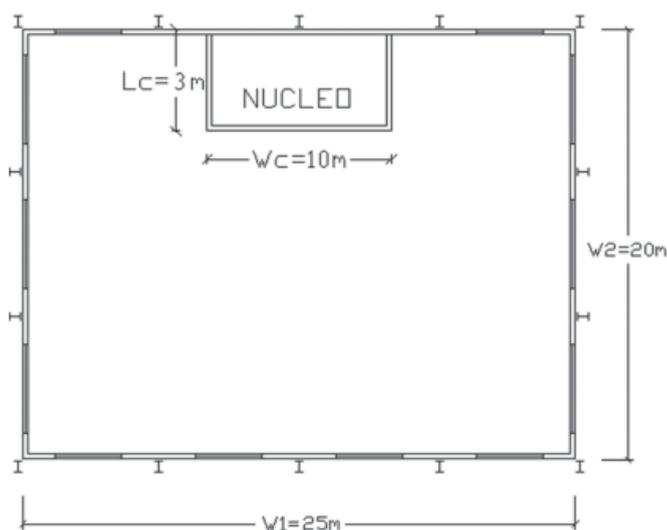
Planta do pavimento tipo de um edifício de escritório.
